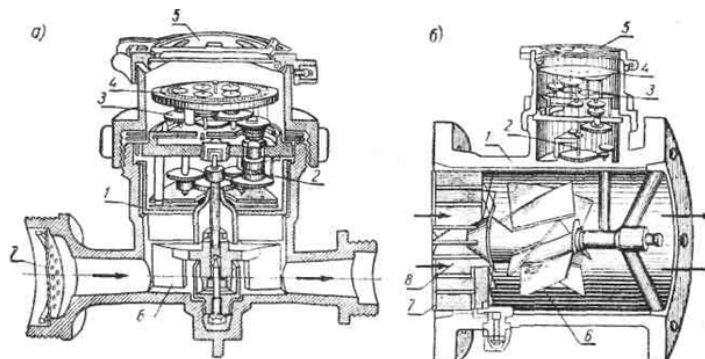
Скоростные водомеры: а – крыльчатый, б – турбинный: 1 – корпус; 2 – передаточный механизм; 3 – счетный механизм; 4 – циферблат; 5 – крышки; 6 – вертушка или турбина; 7 – сетка; 8 – струевыпрямитель.
